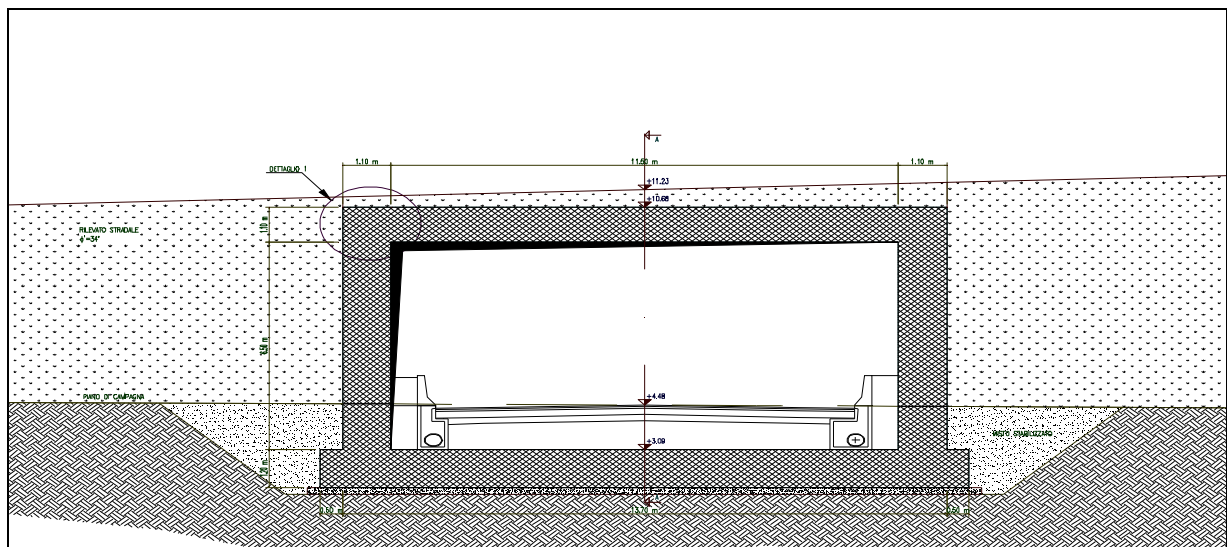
Sezione trasversale B-B del Sottovia Filo Longastrino
